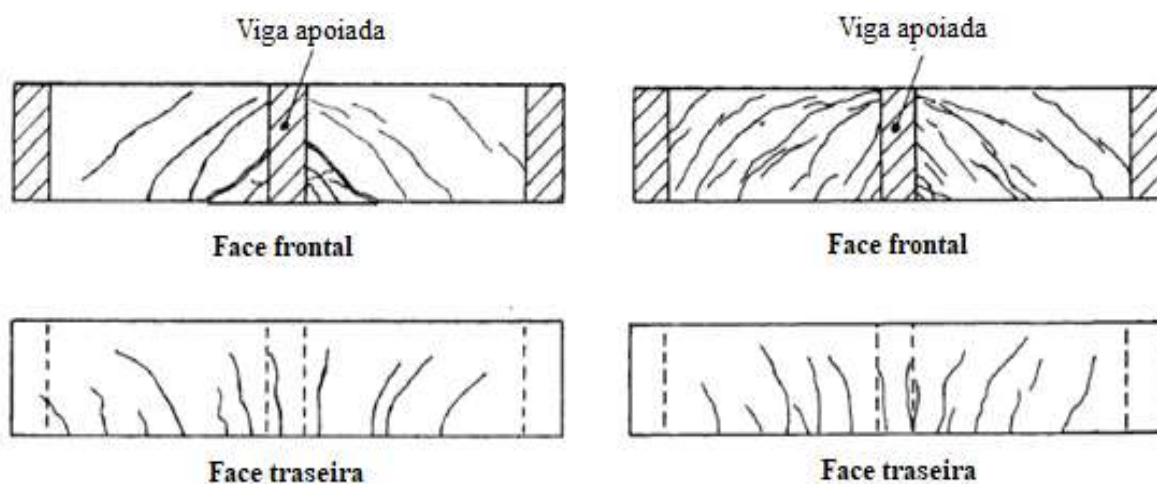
Padrão de fissuração dos corpos de prova 2 e 3
